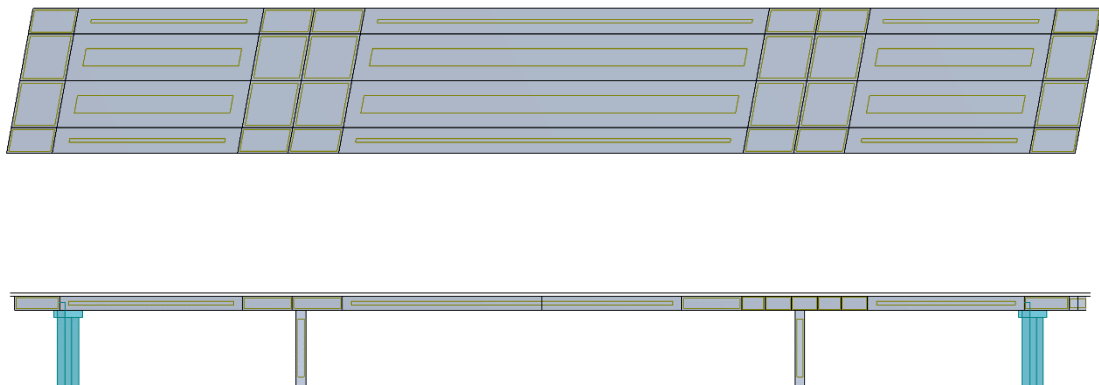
Planta e vista lateral do MEF da passagem superior Z24
